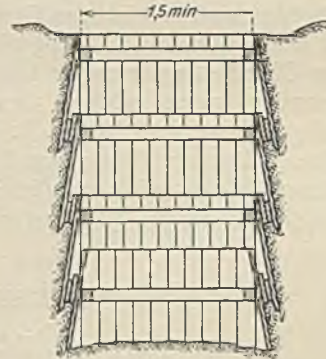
Auszimmerung bei stark treibenden Bodenarten.
